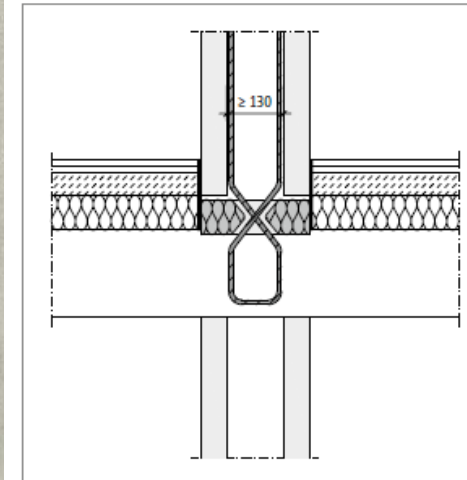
Schöck Sconnex® Typ W: Schematische Darstellung Schöck Sconnex® Typ W bei Doppelwänden und Aufdeckendämmung
